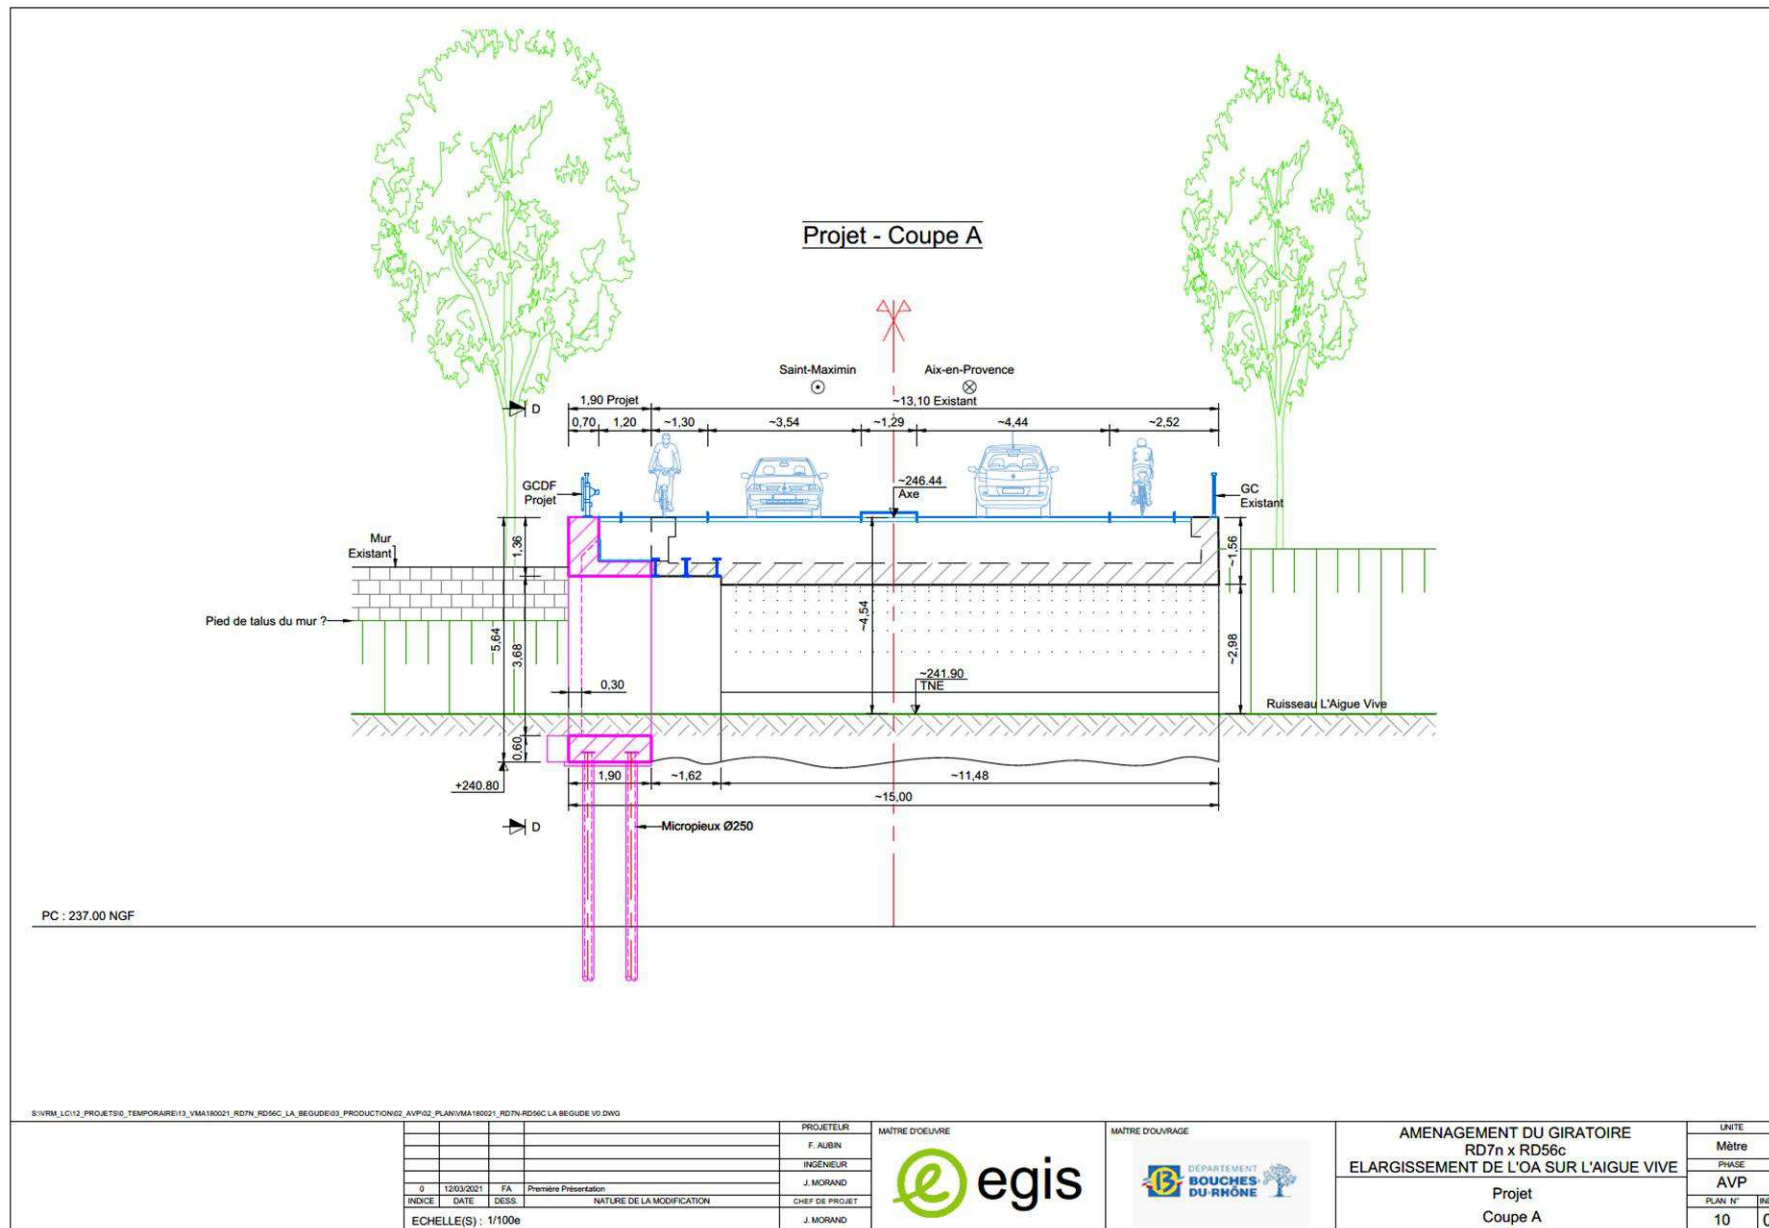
COUPE LONGITUDINALE DE L'OUVRAGE - ÉTAT PROJET
